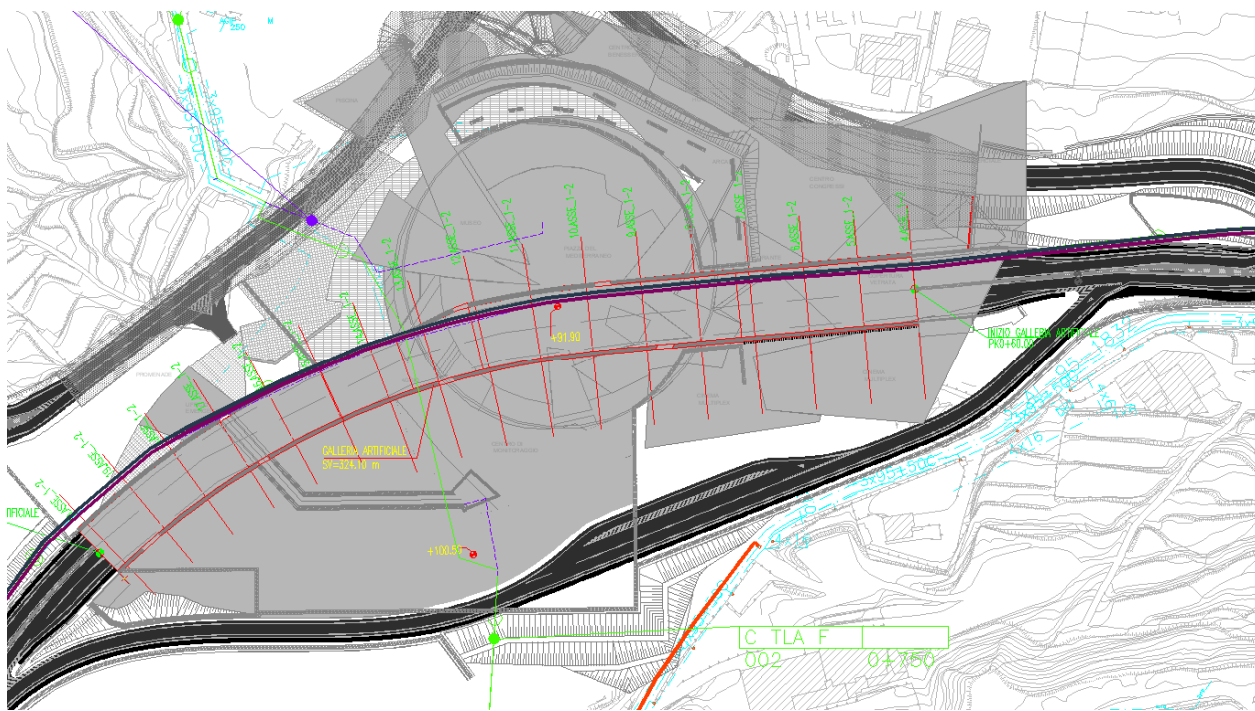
Stralcio planimetrico con l'individuazione delle interferenze
